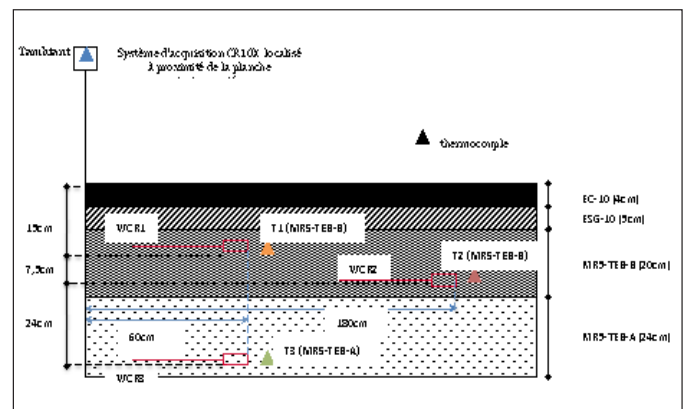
Instrumentation de la chaussée (coupe transversale)
